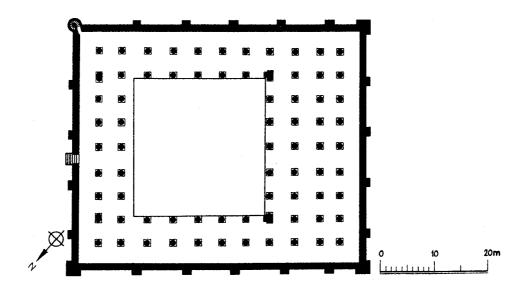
مسقط أفقي لرباط سوسه بتونس . (عن : كريزول) .
